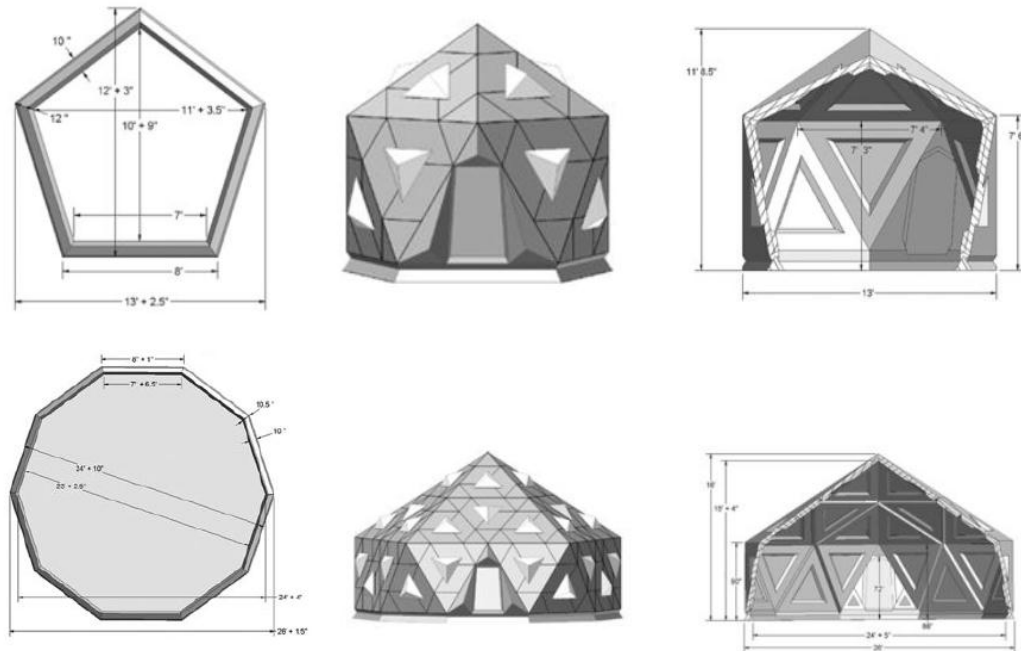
Planta y Sección de la Vivienda Temporal de Papel de Shigeru Ban.
